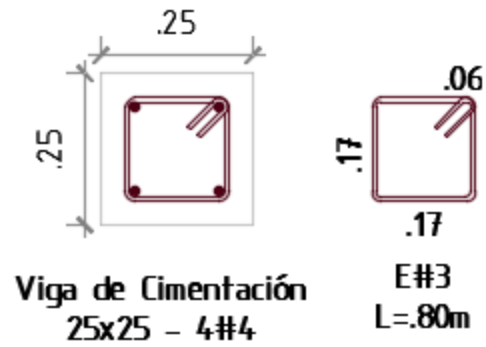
Detalle de refuerzo de vigas de cimentación (a nivel de terreno)
